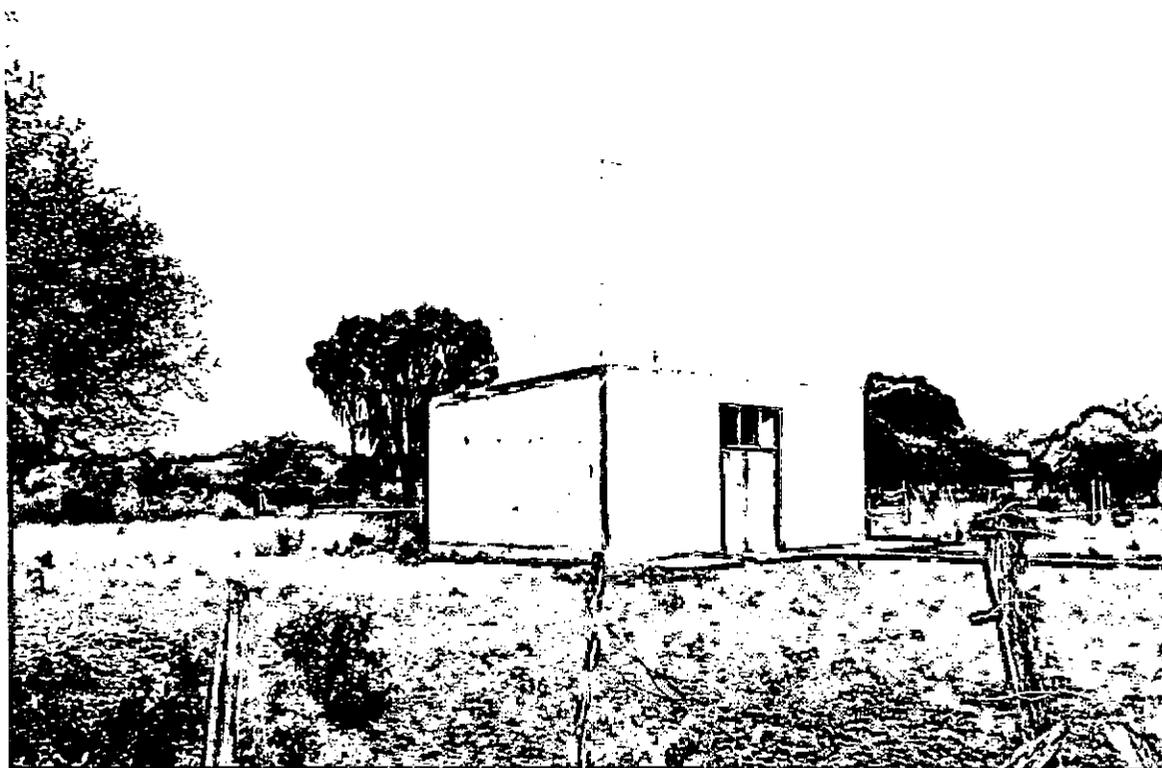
Puesto Sanitario. Se prevé la conexión del techo a la pileta existente dotándola a esta de losa con tapa metálica y bomba sapo. Se proyecta además la provisión de vidrios para el portón de ingreso, además de un módulo sanitario (baño) completo.
